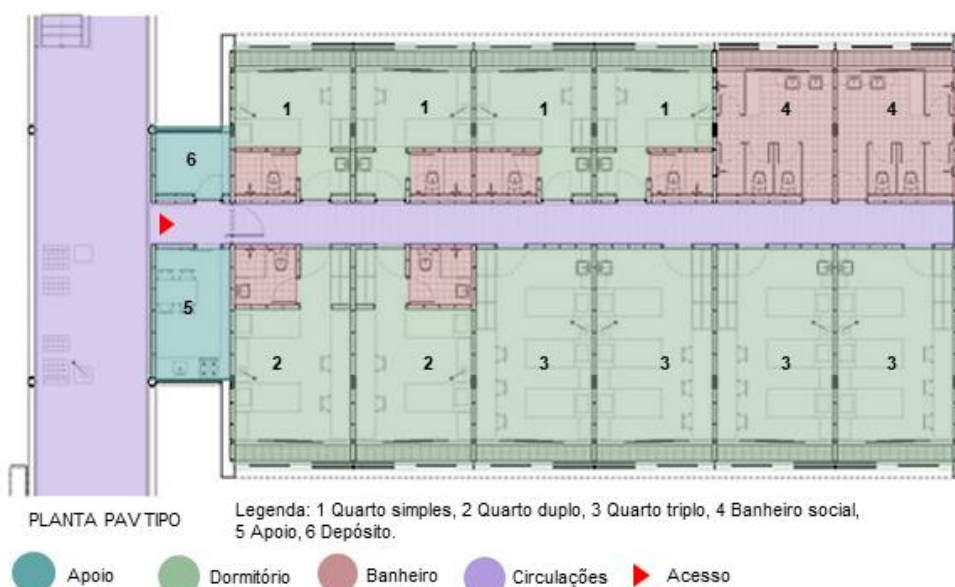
Análise da setorização do pavimento tipo. Figura modificada pelo autor.
